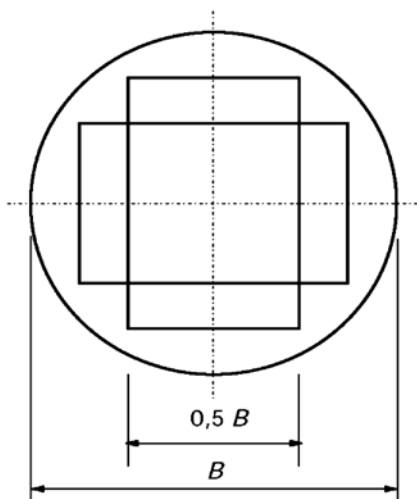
Ортогональна арматура у круглому фундаменті на основі
